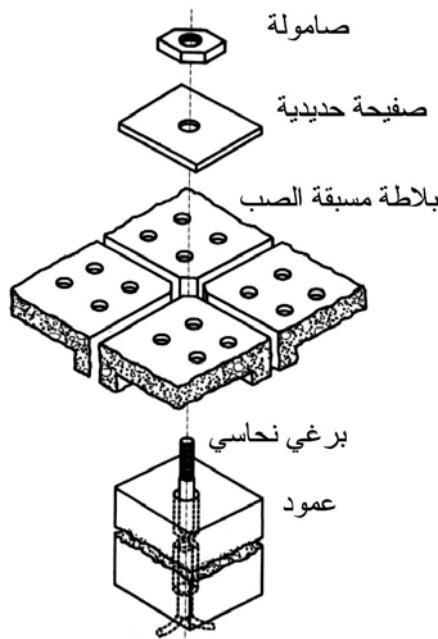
قاع المرشح إضافي مصطنع مكون من بلاطة مسبقة الصب مع رساشات للغسيل العكسي
